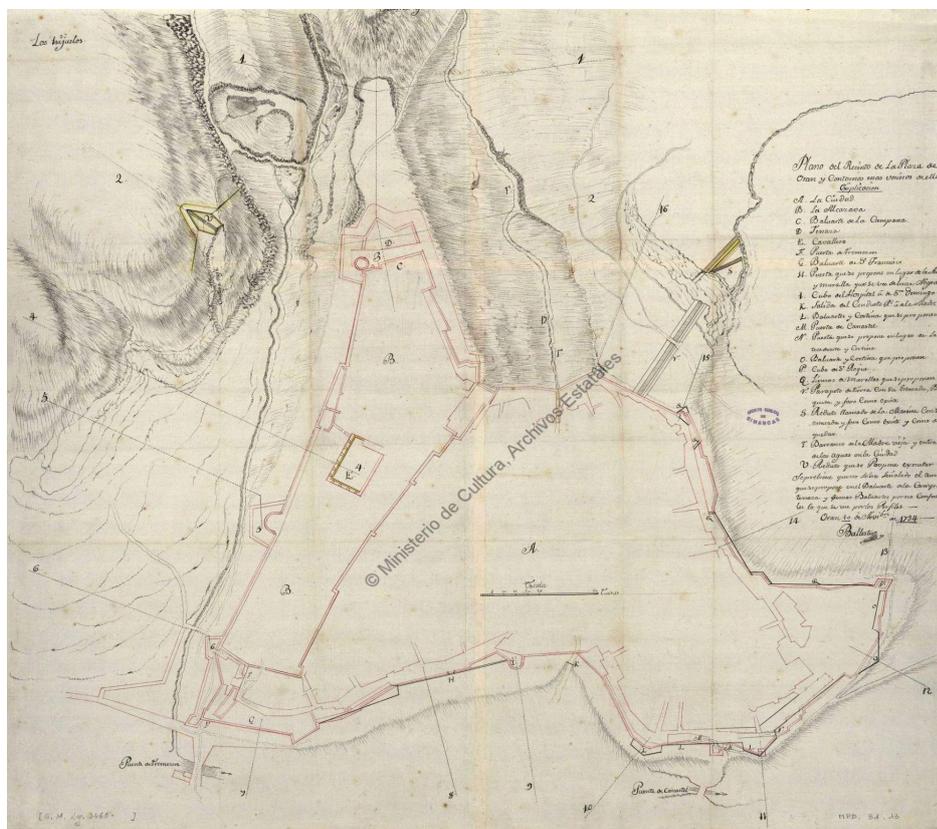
Planta de la Alcazaba y la plaza de Orán por Juan Ballester en 1734 (AGS, SGU. Leg.03460, MPD, 31, 013).
